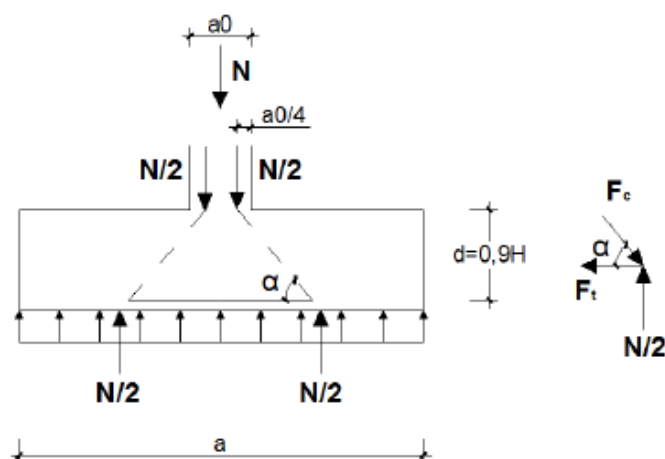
Cálculo de armaduras para sapatas com carga centrada.
